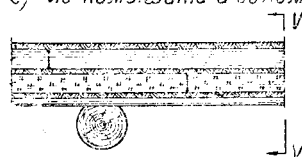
Чердачные перекрытия с настилом из соломы и камыша
